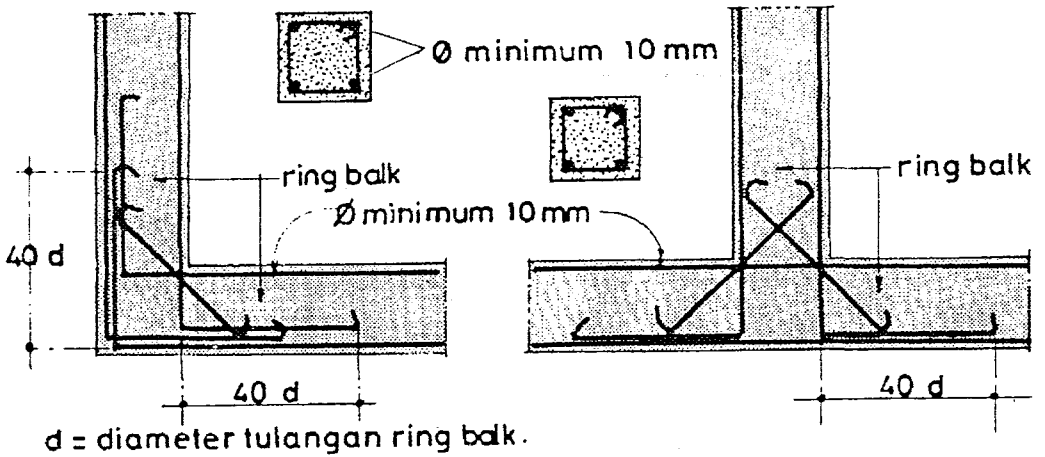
Detail Penulangan Ikatan Kolom dan Ring Balok
